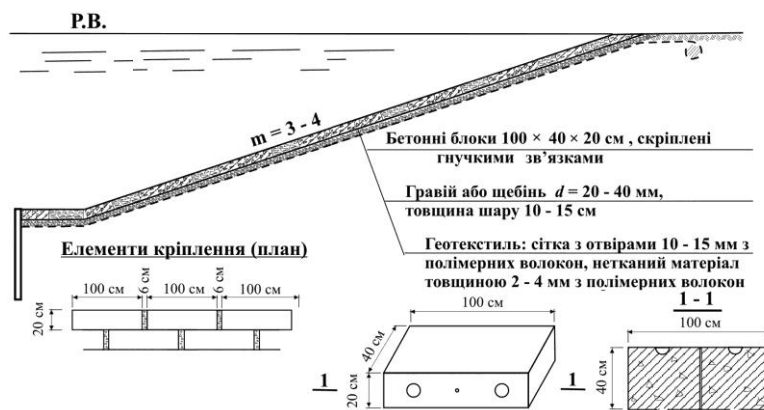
Кріплення з бетонних блоків з шаром щебеню
